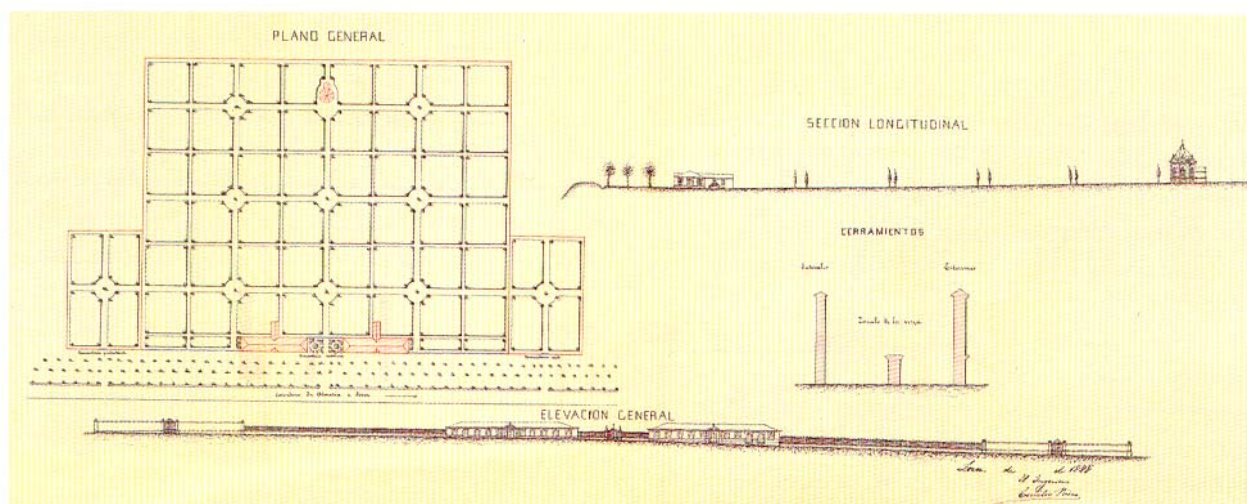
Plano general, sección longitudinal y cerramientos del cementerio. Ingeniero Riera. 1888
